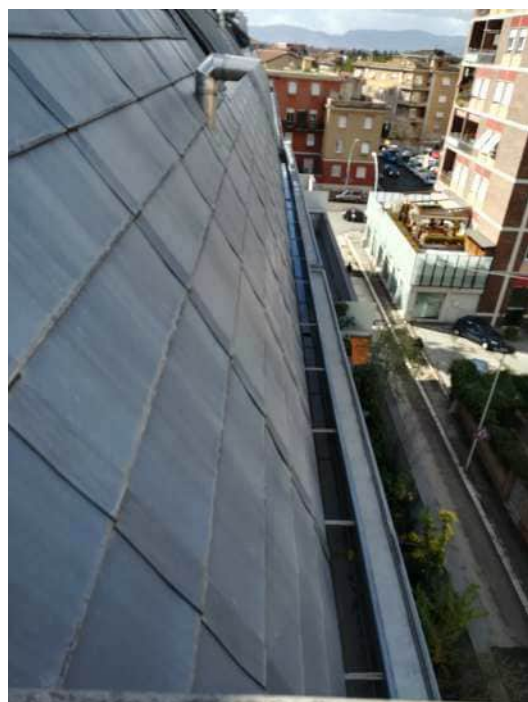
vista del lastrico solare - parapetto e pozzetti di raccolta.
